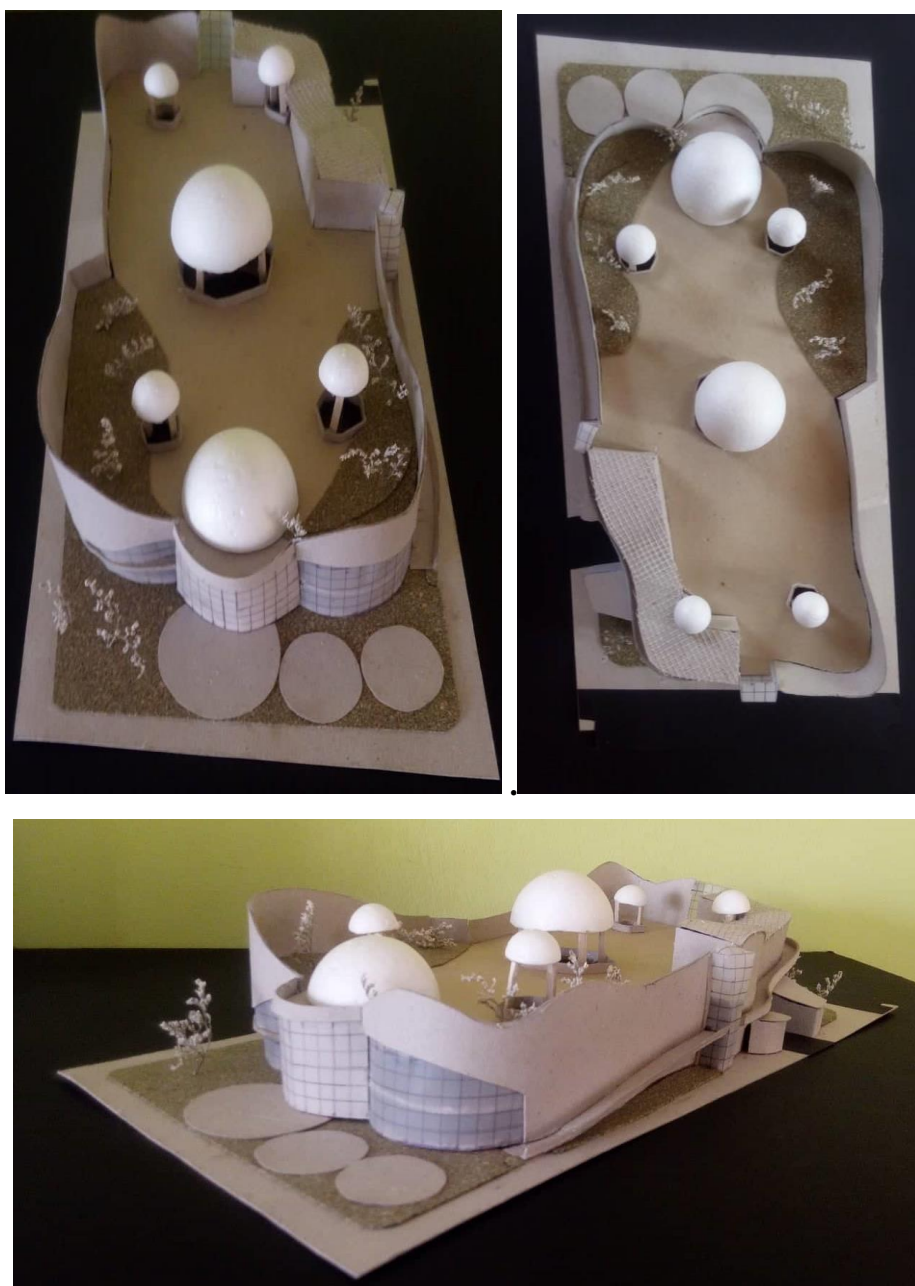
Plan de Masas (Maqueta Conceptual). Fuente: Elaboración propia.
